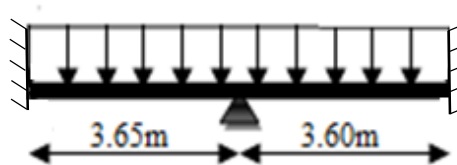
schéma statique de la poutrelle à deux travées
